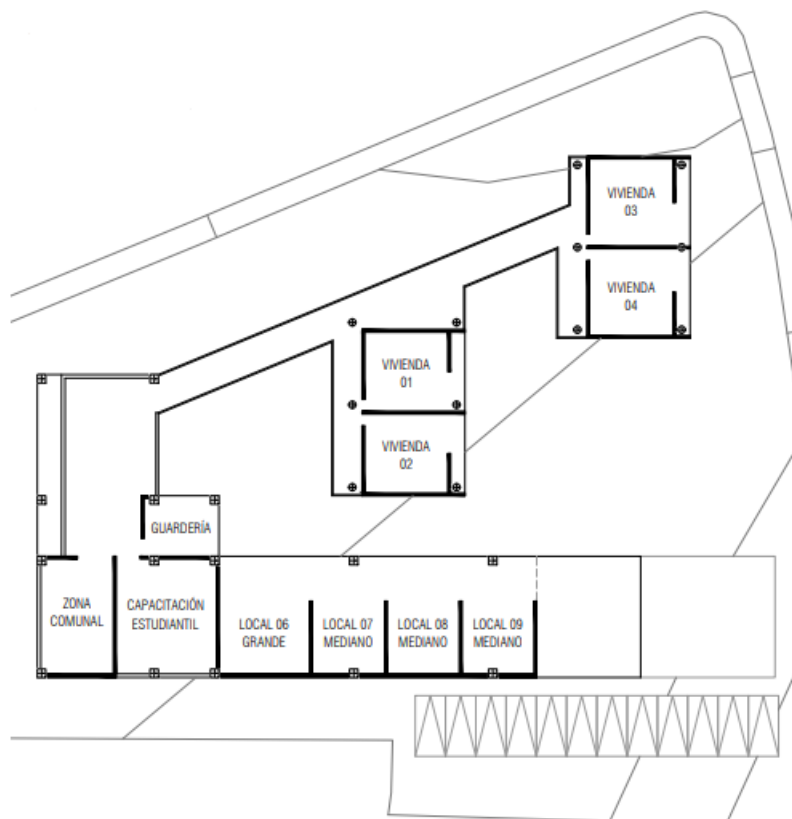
Planta alta - Anteproyecto 01. Elaboración propia.
